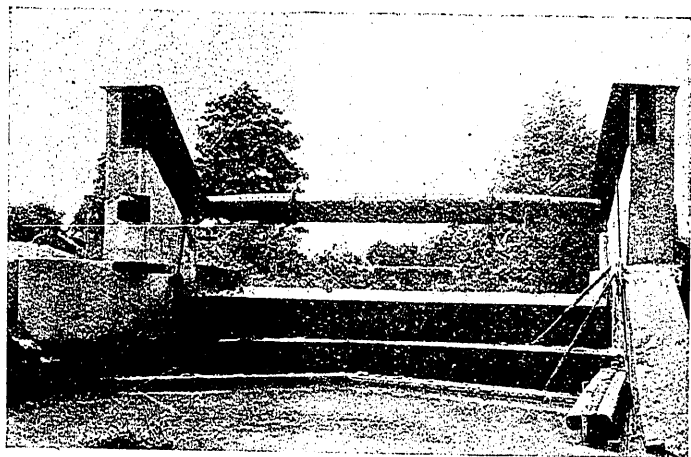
Alza automática con contrapeso móvil de Sirnach.
